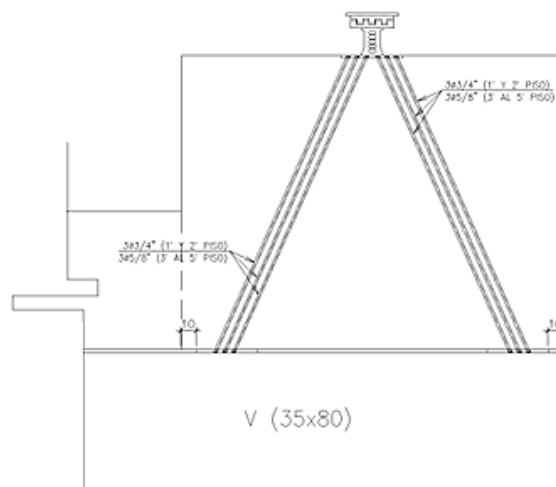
Elevación de muro desacoplado y dispositivos SLB
